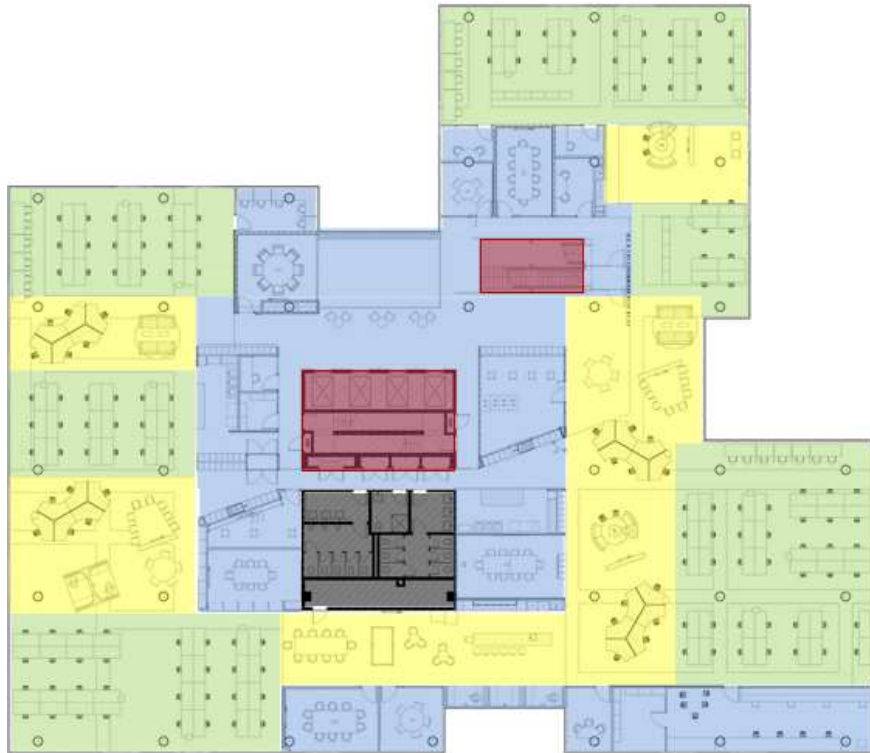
Planta baixa do primeiro pavimento editada pela autora.
